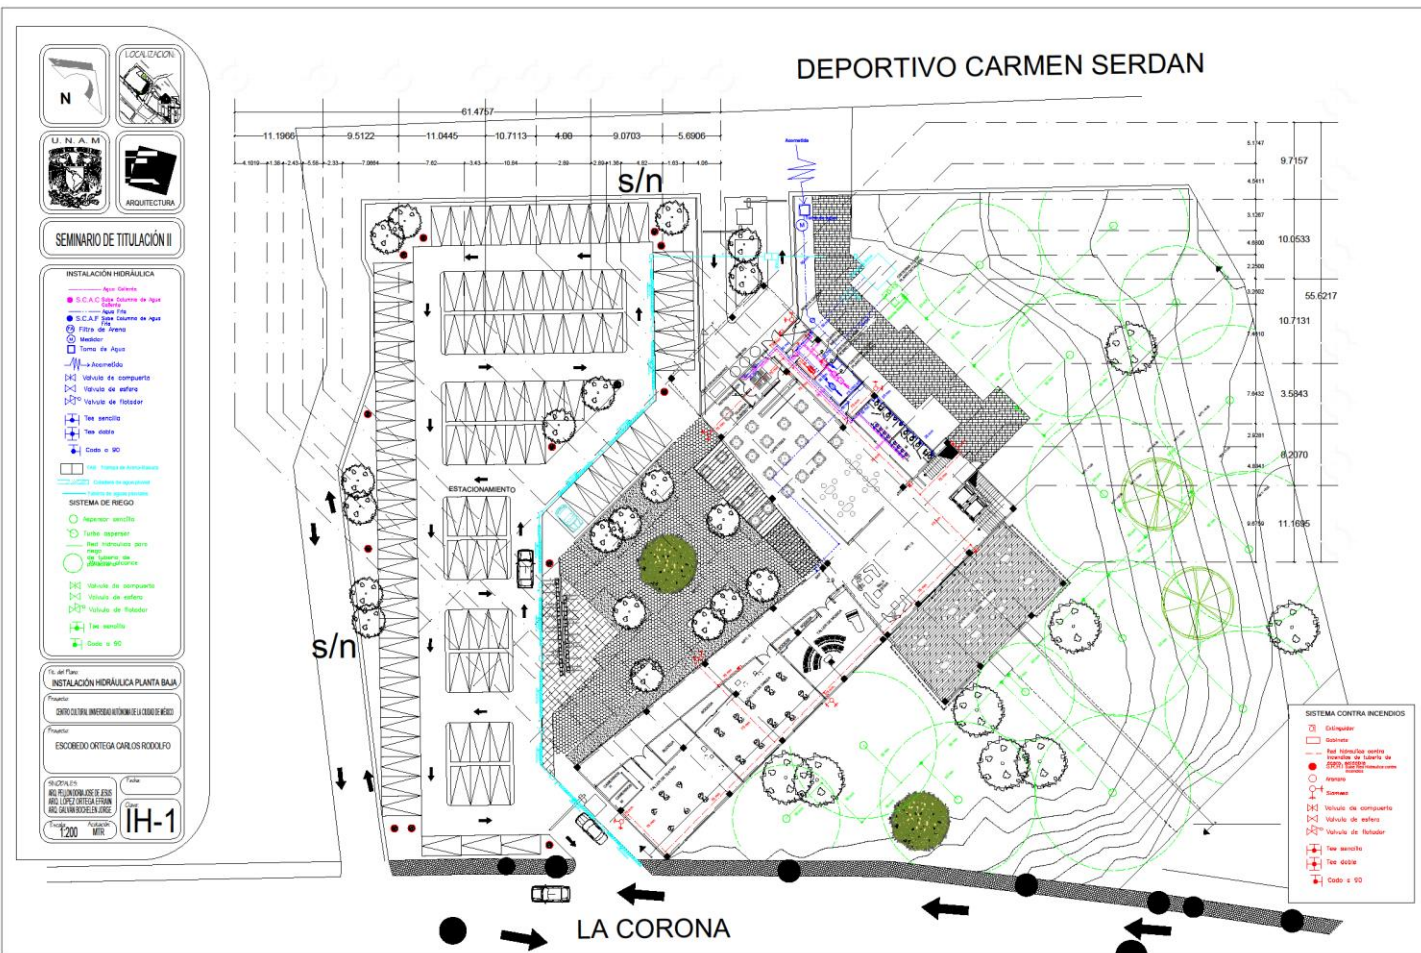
Planta baja de instalación hidráulica del Centro cultural UACM plantel Cuauhtemoc. Creación propia.
